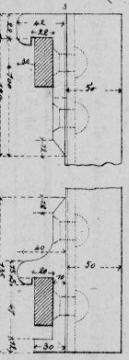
Plan du côté N du poteau de manœuvre (1/5)
